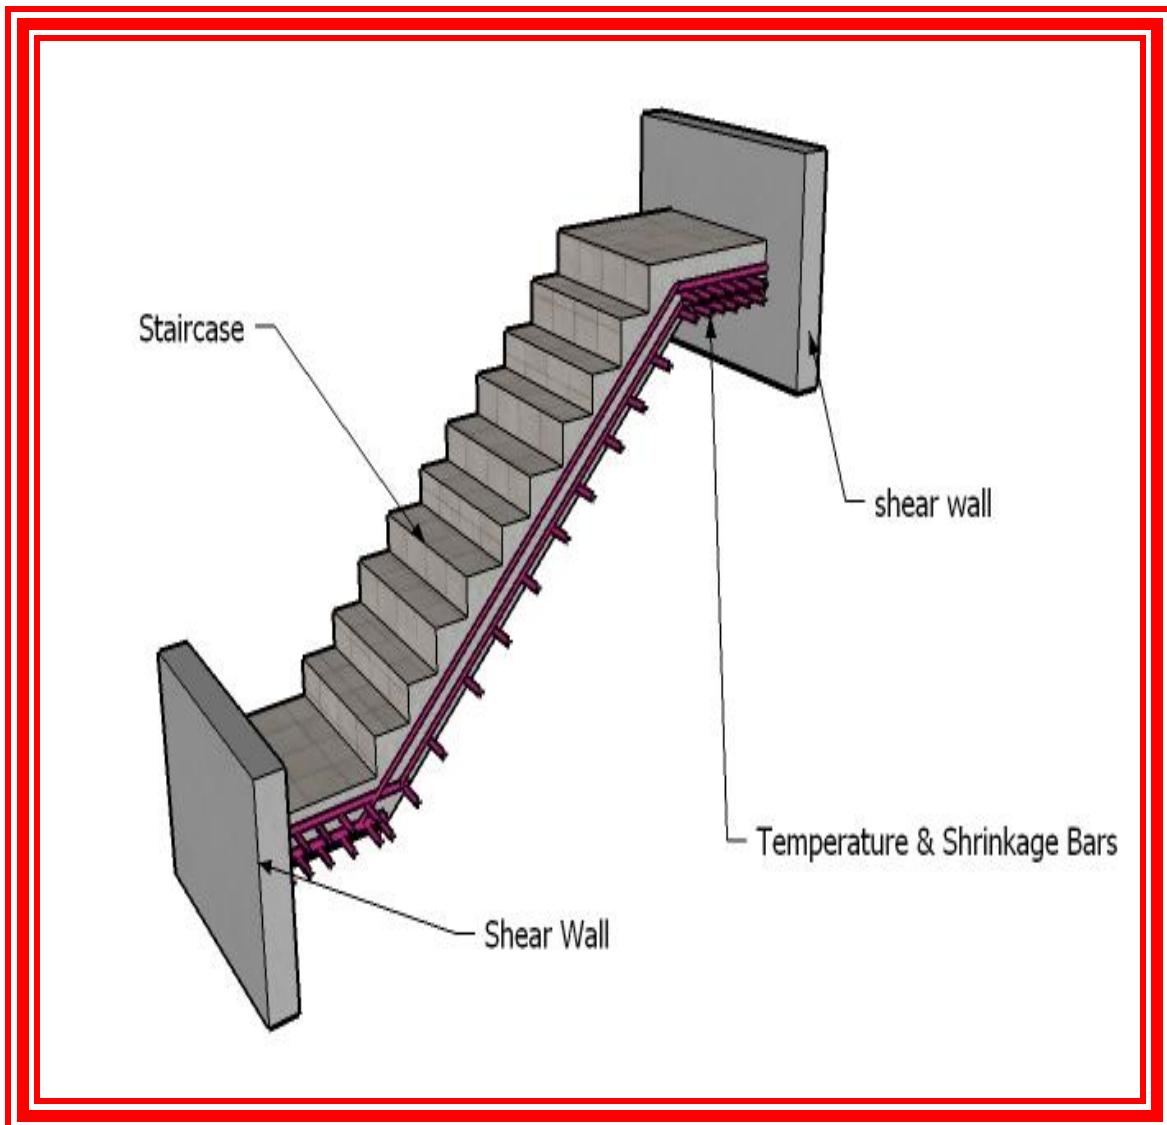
يبين شكل عقدة مصممة باتجاه واحد.
